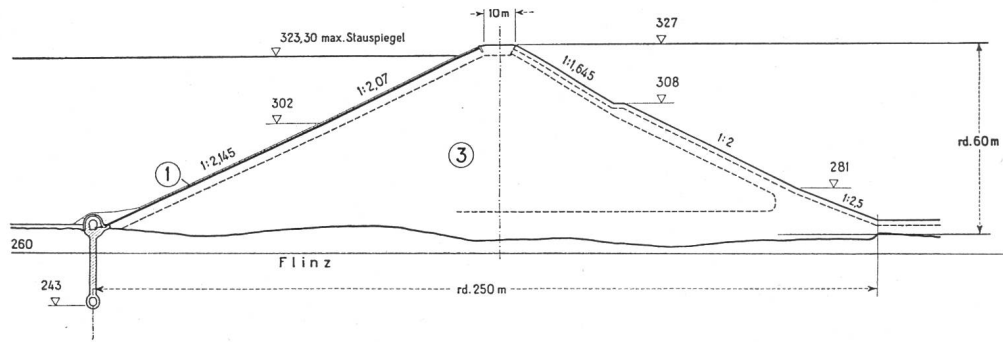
Staudamm mit Oberflächendichtung. ① Dichtungsdecke ③ Stützkörper.
